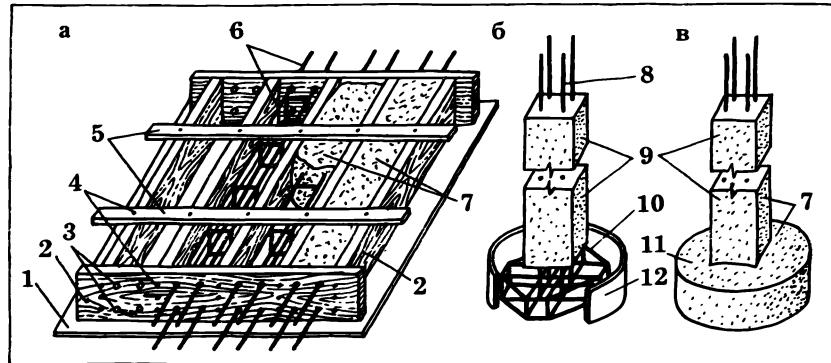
Последовательность изготовления столбчатых железобетонных фундаментов
